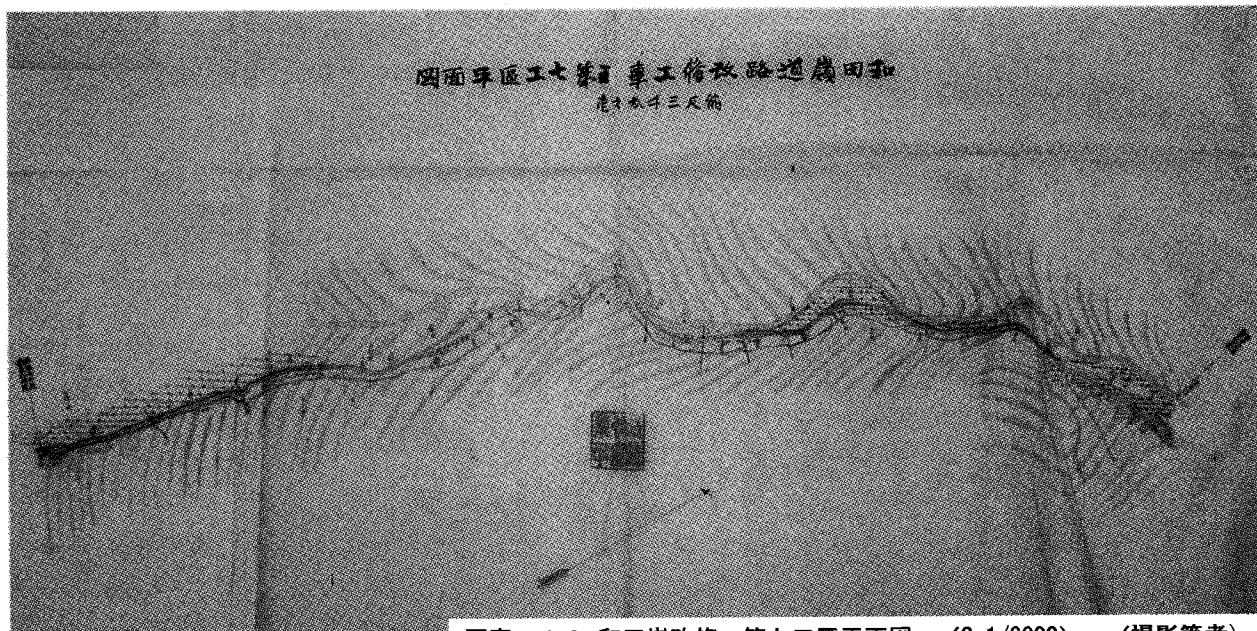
和田嶺改修 第七工区平面図 (S=1/3000) (撮影筆者)
